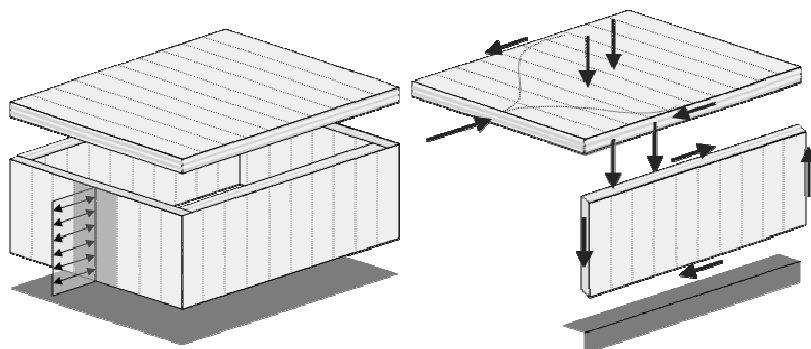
Struttura tridimensionale di un edificio a un piano e trasmissione dei carichi orizzontali agenti sulle pareti
